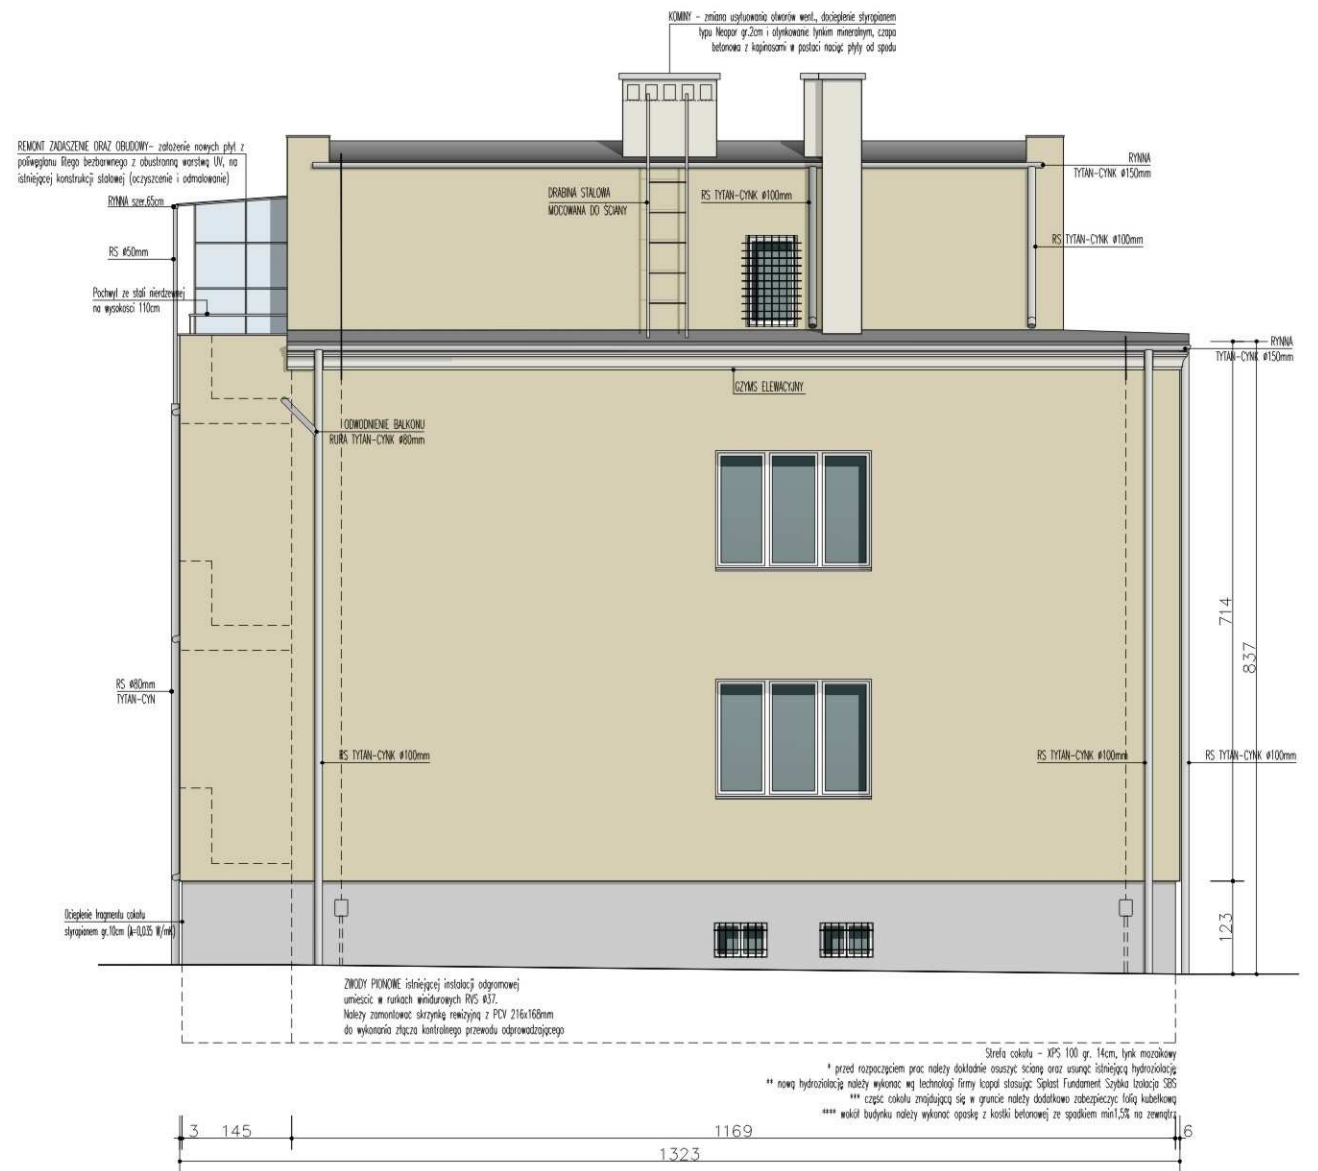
Elewacja frontowa - północna (od strony ulicy Cichej)
